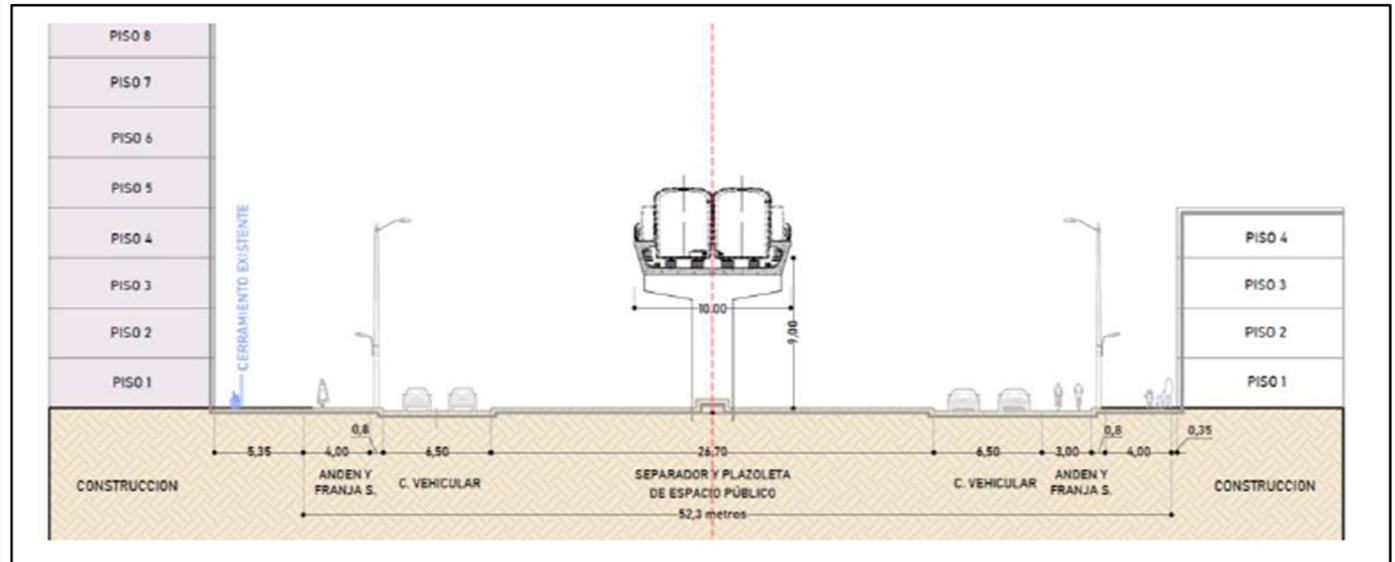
Tramo 8 – Perfil vial proyectado V2 – Metro elevado en viaducto
